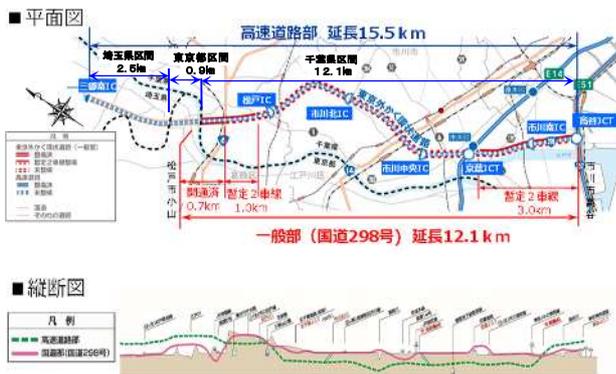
外環道 三郷南 IC～高谷 JCT 間の平面・縦断面図
